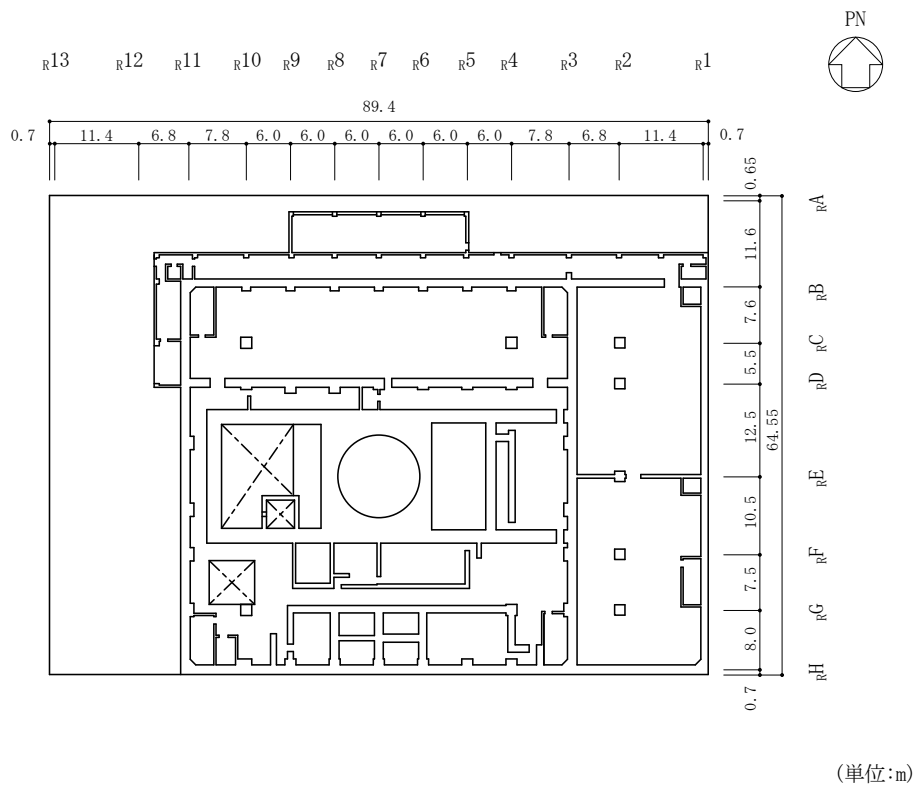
(6) 原子炉建物の概略平面図 (EL 34.8m)
